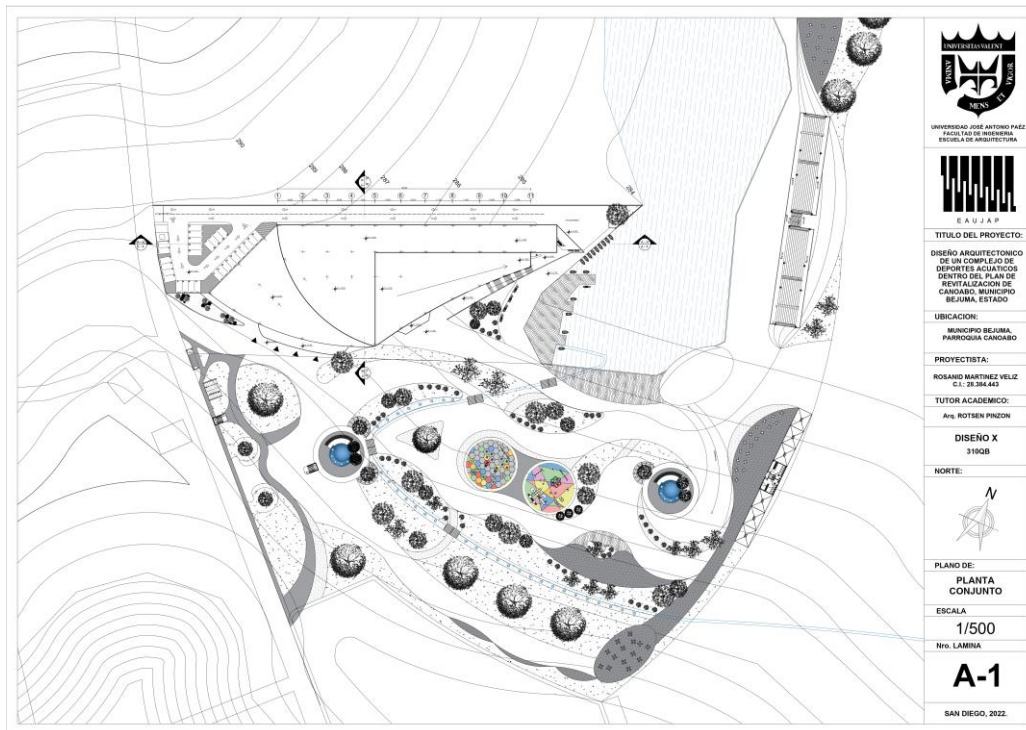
Planta Techo Conjunto. Fuente: La autora (2022).
